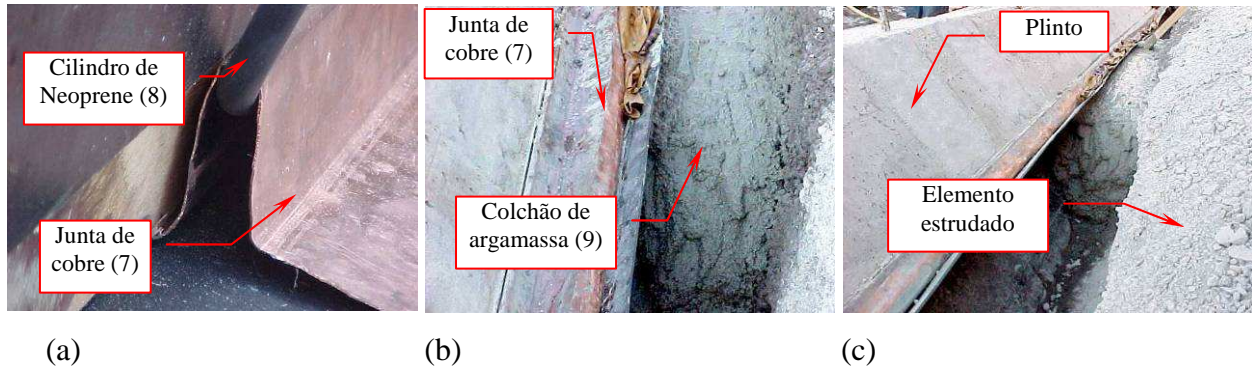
Detalhe típico da Junta Perimetral.
